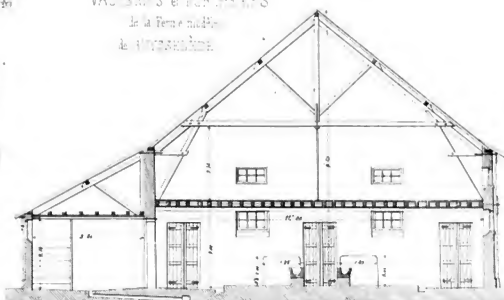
Elevation latérale à 0.18 pour l'no (1/20)
